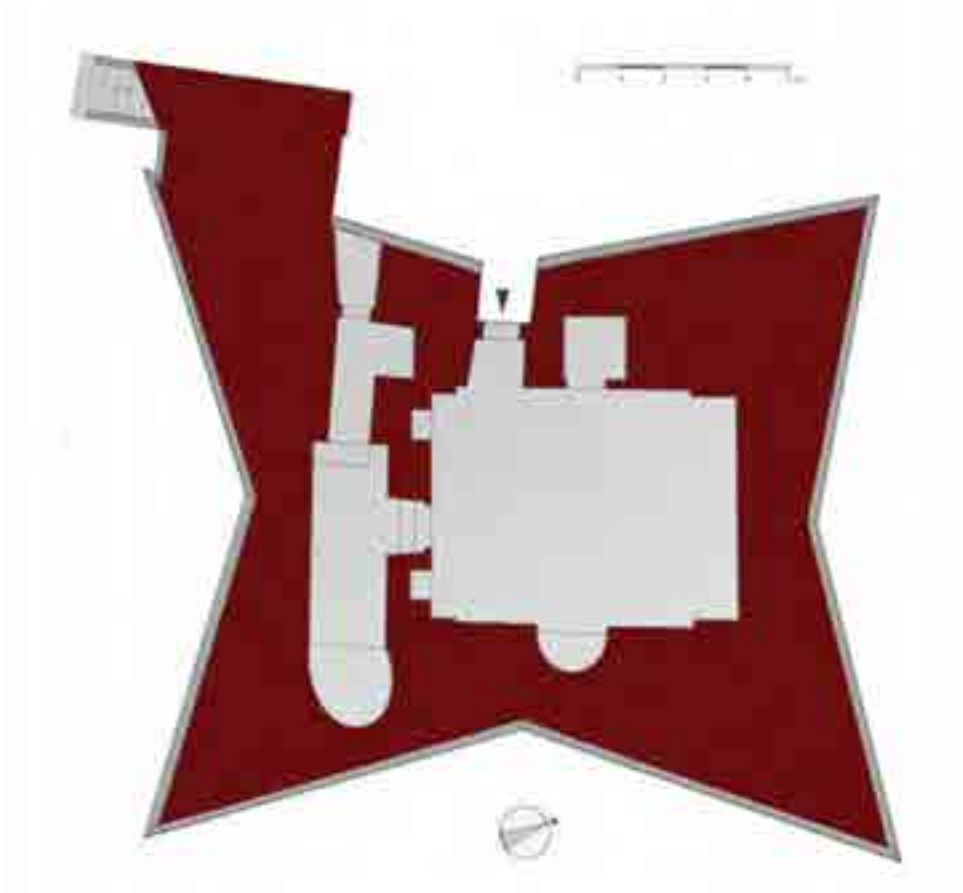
Torre di S. Pietro in Bevagna. Ipotesi della pianta del complesso nel XIX secolo (quota + m. 4,50).
